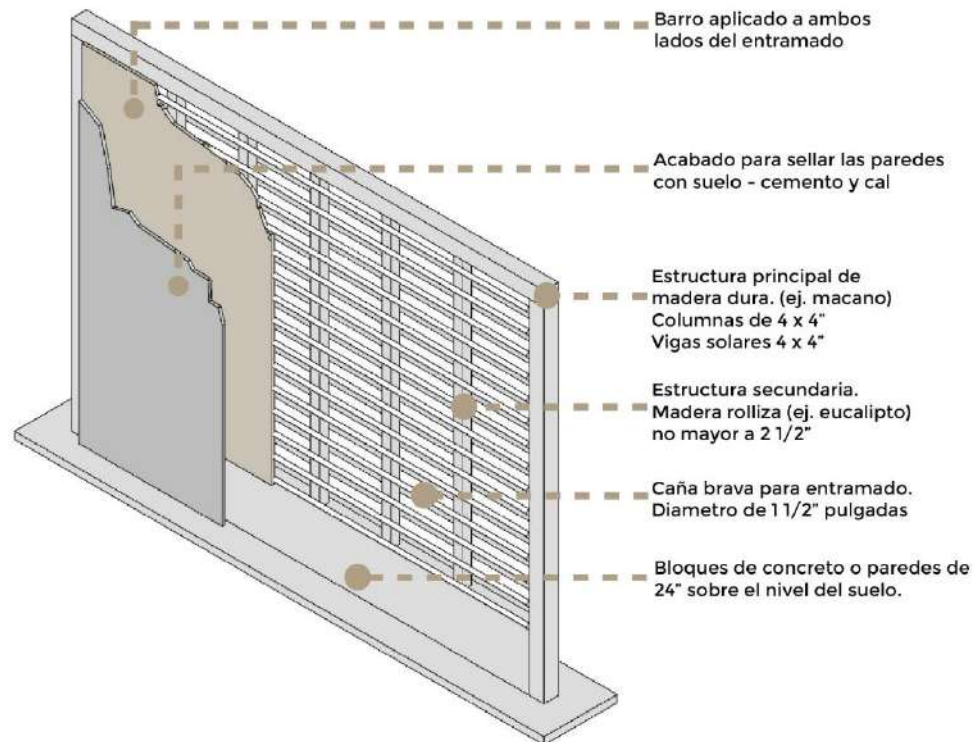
Propuesta para estructura de una casa tradicional de quincha. [Realizado por autor]
